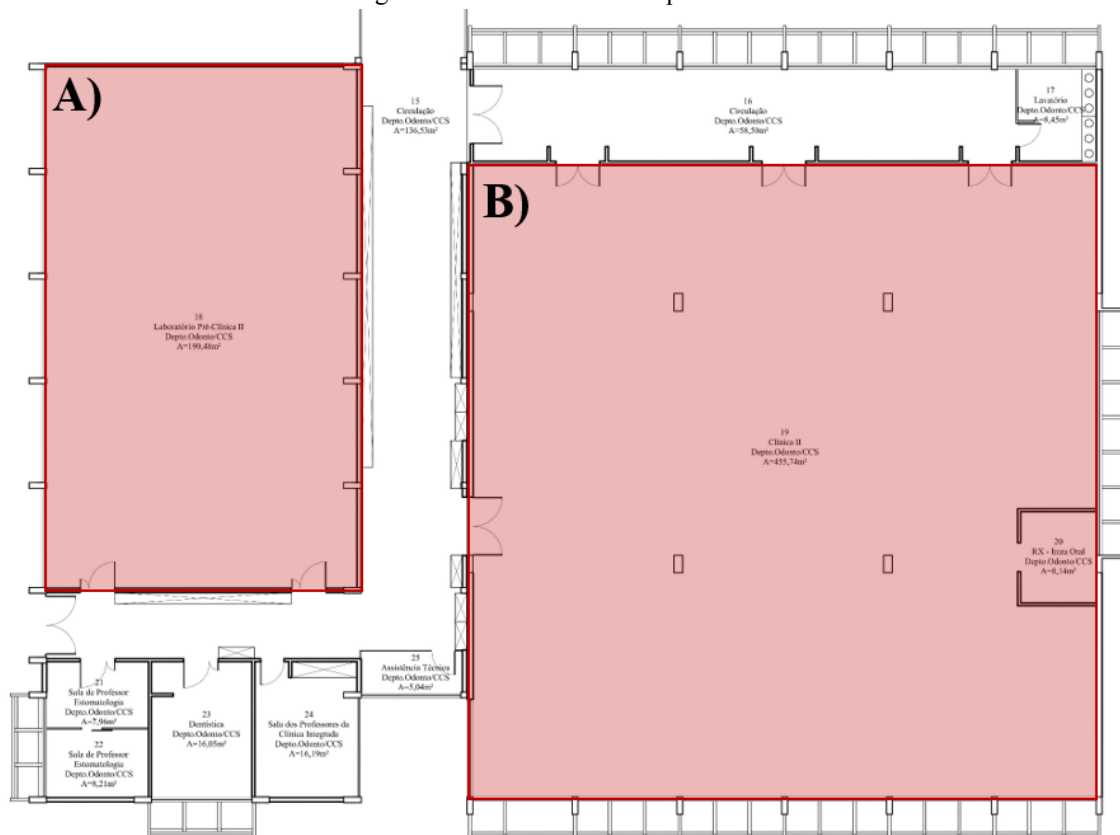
Planta baixa do 3º pavimento, Bloco D, CCS. Com destaque em: A) Laboratório II; B) Clínica II
